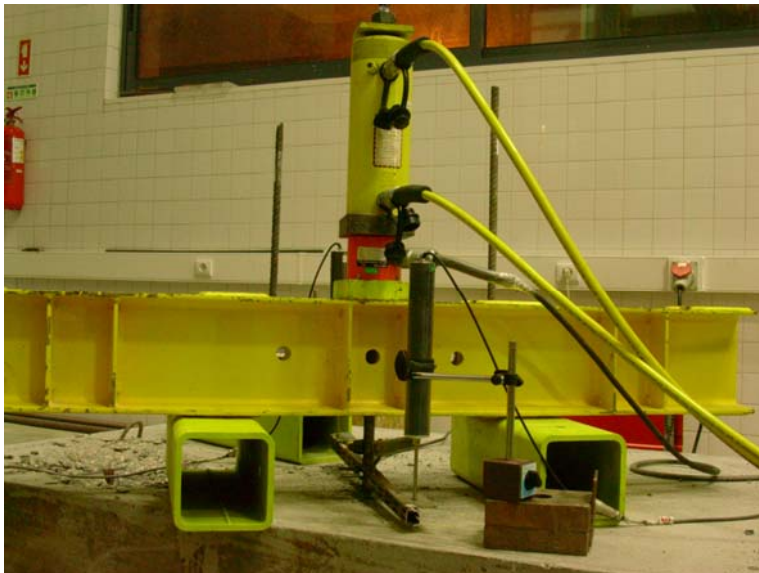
Configuração do ensaio para varões posicionados no centro do maciço de betão
